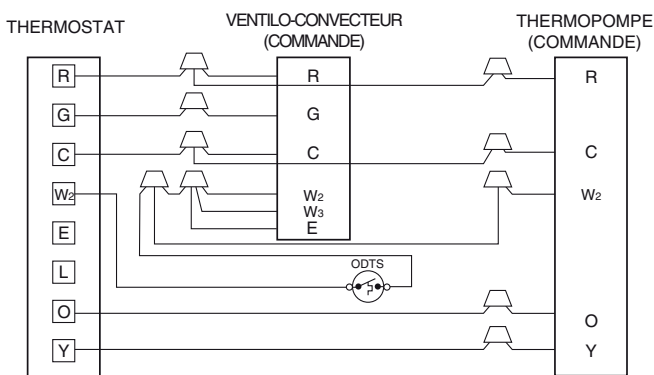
Agencement du câblage – Thermopompe (refroidissement et chauffage 2 étages pour maisons préfabriquées)
